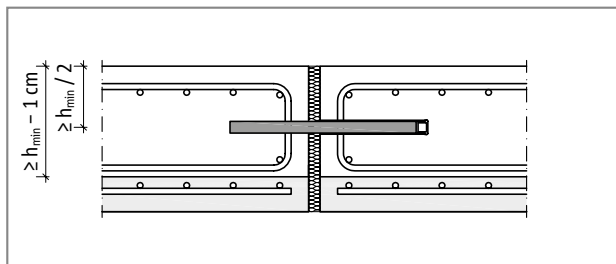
Schöck Dorn type LD : Disposition de l'armature chantier dans les dalles semi-finies
